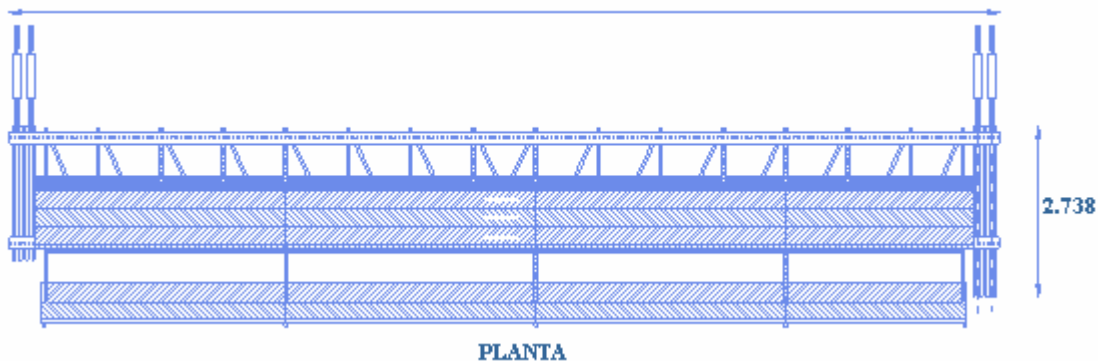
Cimbra deslizante para el colado de las losas de concreto.
